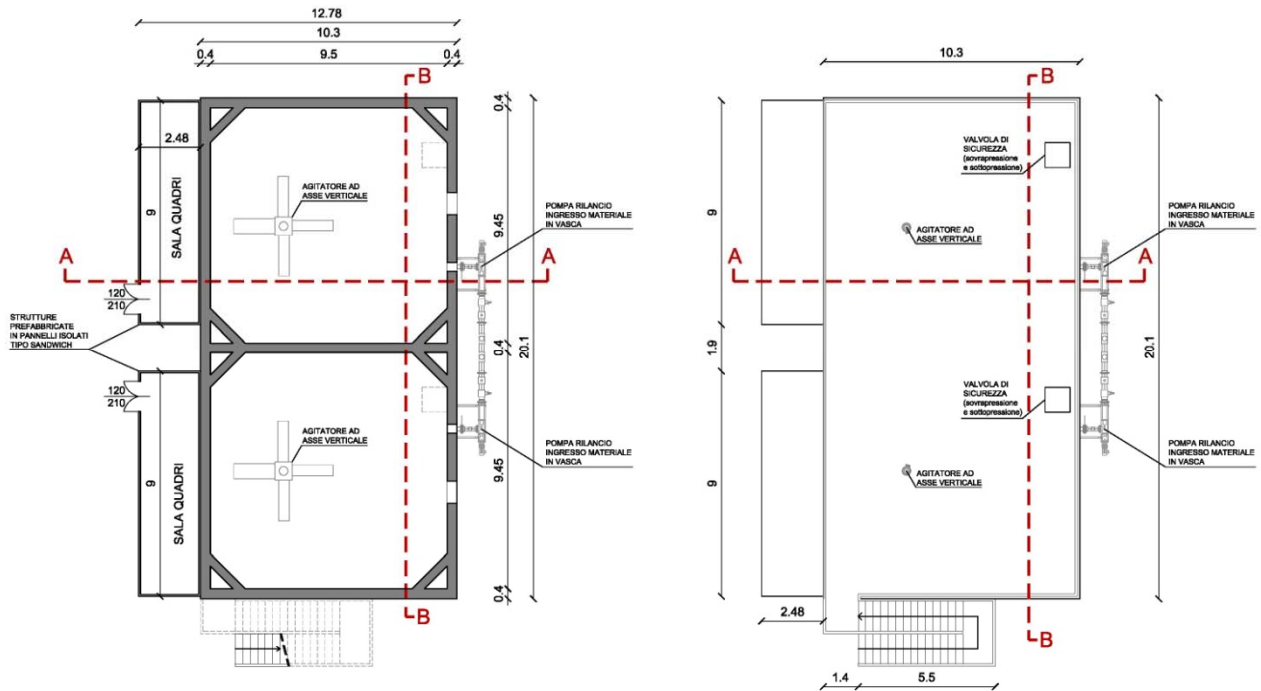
Pianta delle vasche di precarico - a sinistra pianta a quota +1,20m a destra pianta della copertura
